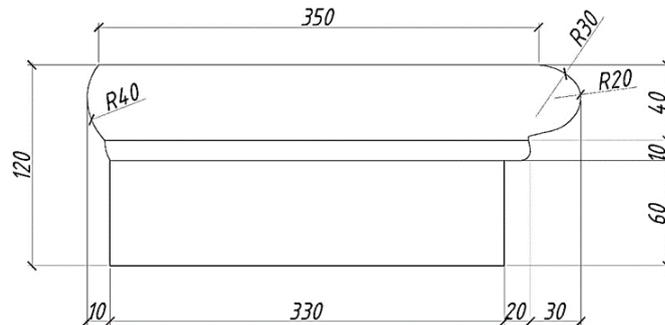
Обмерочный чертеж профиля ступени. Чертёж М.А. Вольных, 2016 г.
